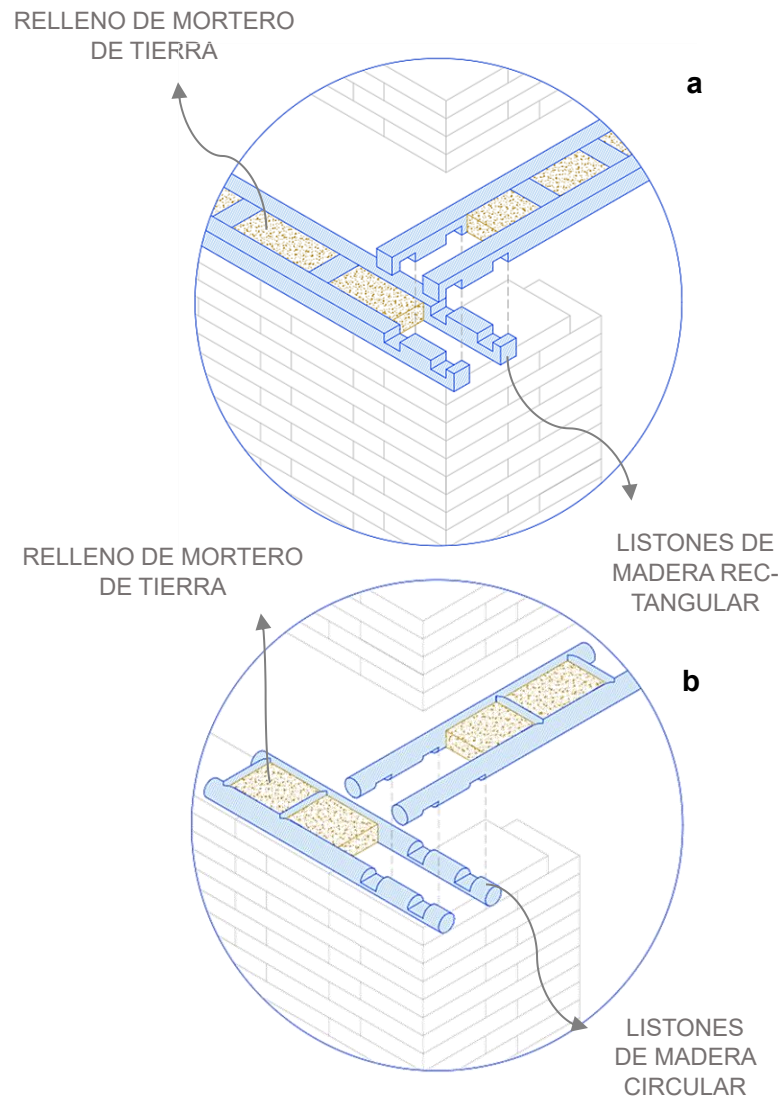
a) Dispositivo DC con de sección rectangular; b) Dispositivo DC con sección circular. Fuente: Elaboración propia.
